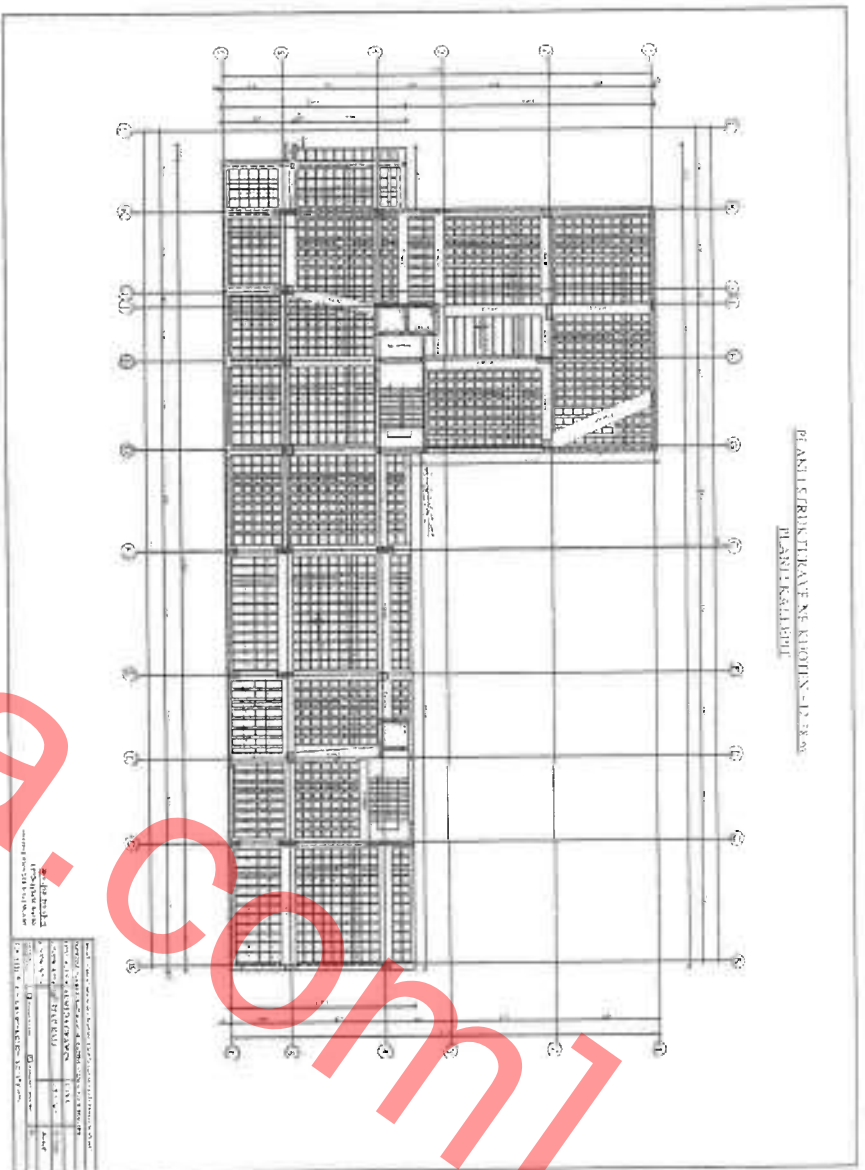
Plani i Strukturave ne Kuotën +12.38 m, Plani i Kallepit
